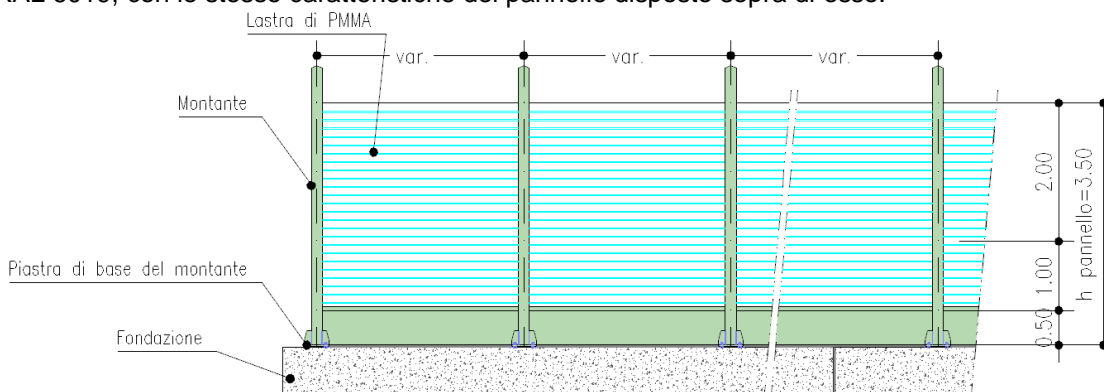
Barriera TRASPARENTE H=3,5m – Prospetto lato ricettore
